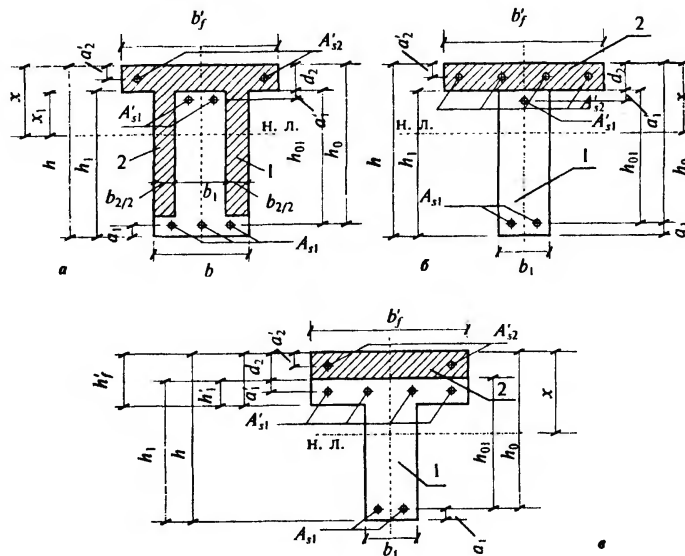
Поперечное сечение балки, усиливаемой наращиванием бетона сжатой зоны
